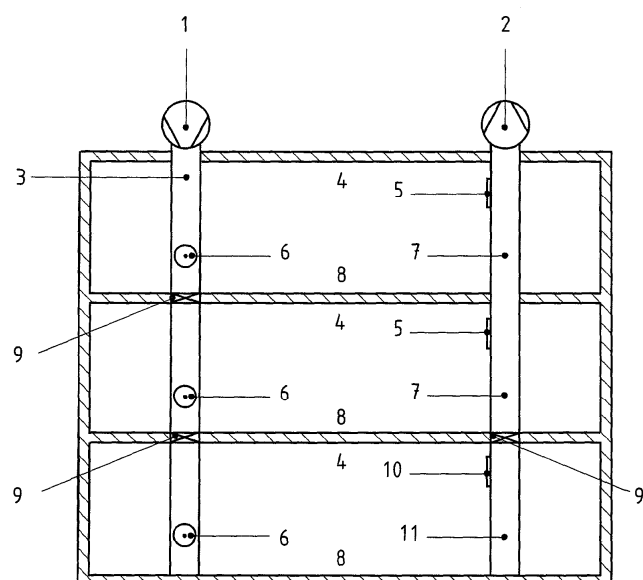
В. Механическая вентиляция тепло- и дымоудаления в одном помещении с внутренним вентилятором
